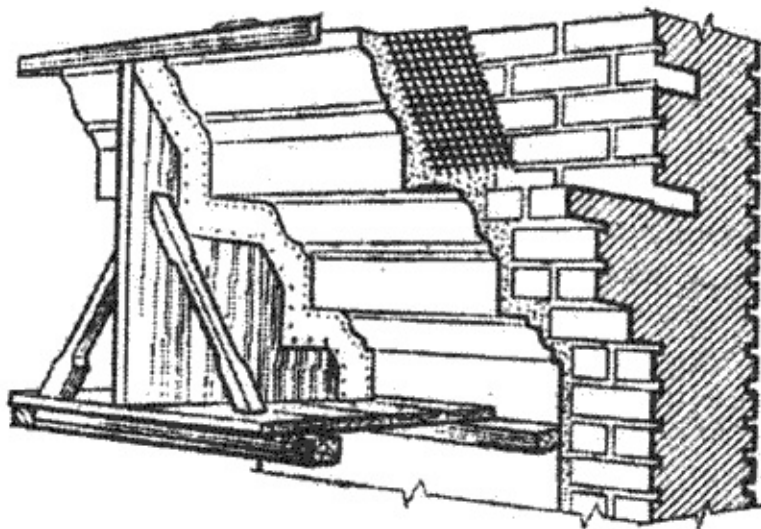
Вытягивание венчающего карниза на фасаде здания
